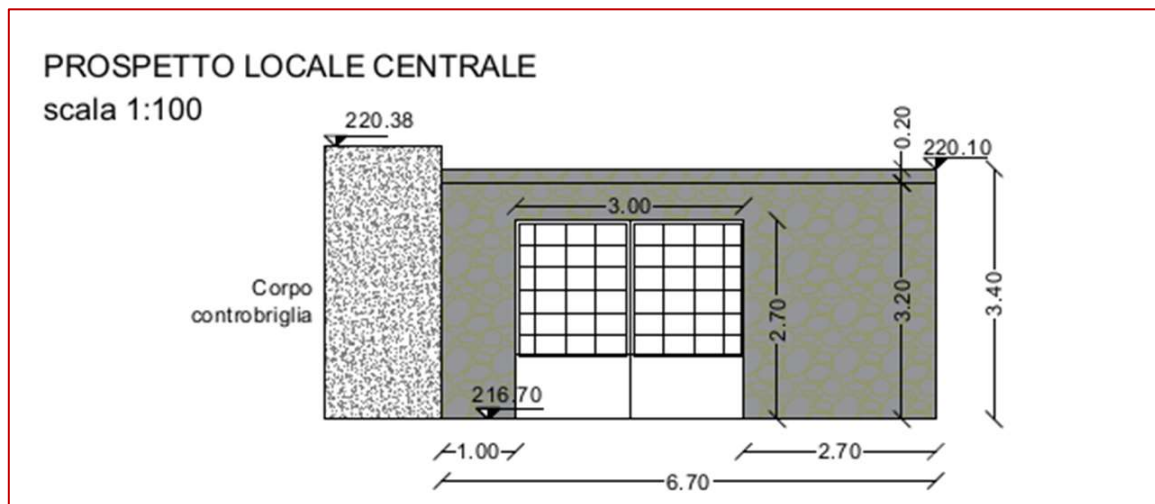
Interventi in progetto, Prospetto del locale turbina (da elaborato LON.PD.RR.OO.01 Relazione tecnica generale.09.2023 Rev1, Fig.3.3)
